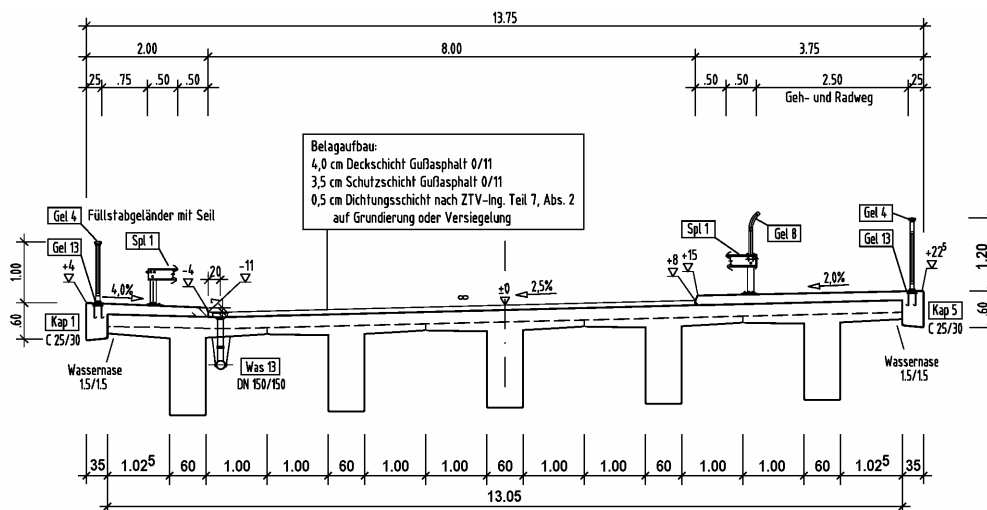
Herkömmliche Spannbetonbrücke über eine Bundesautobahn
